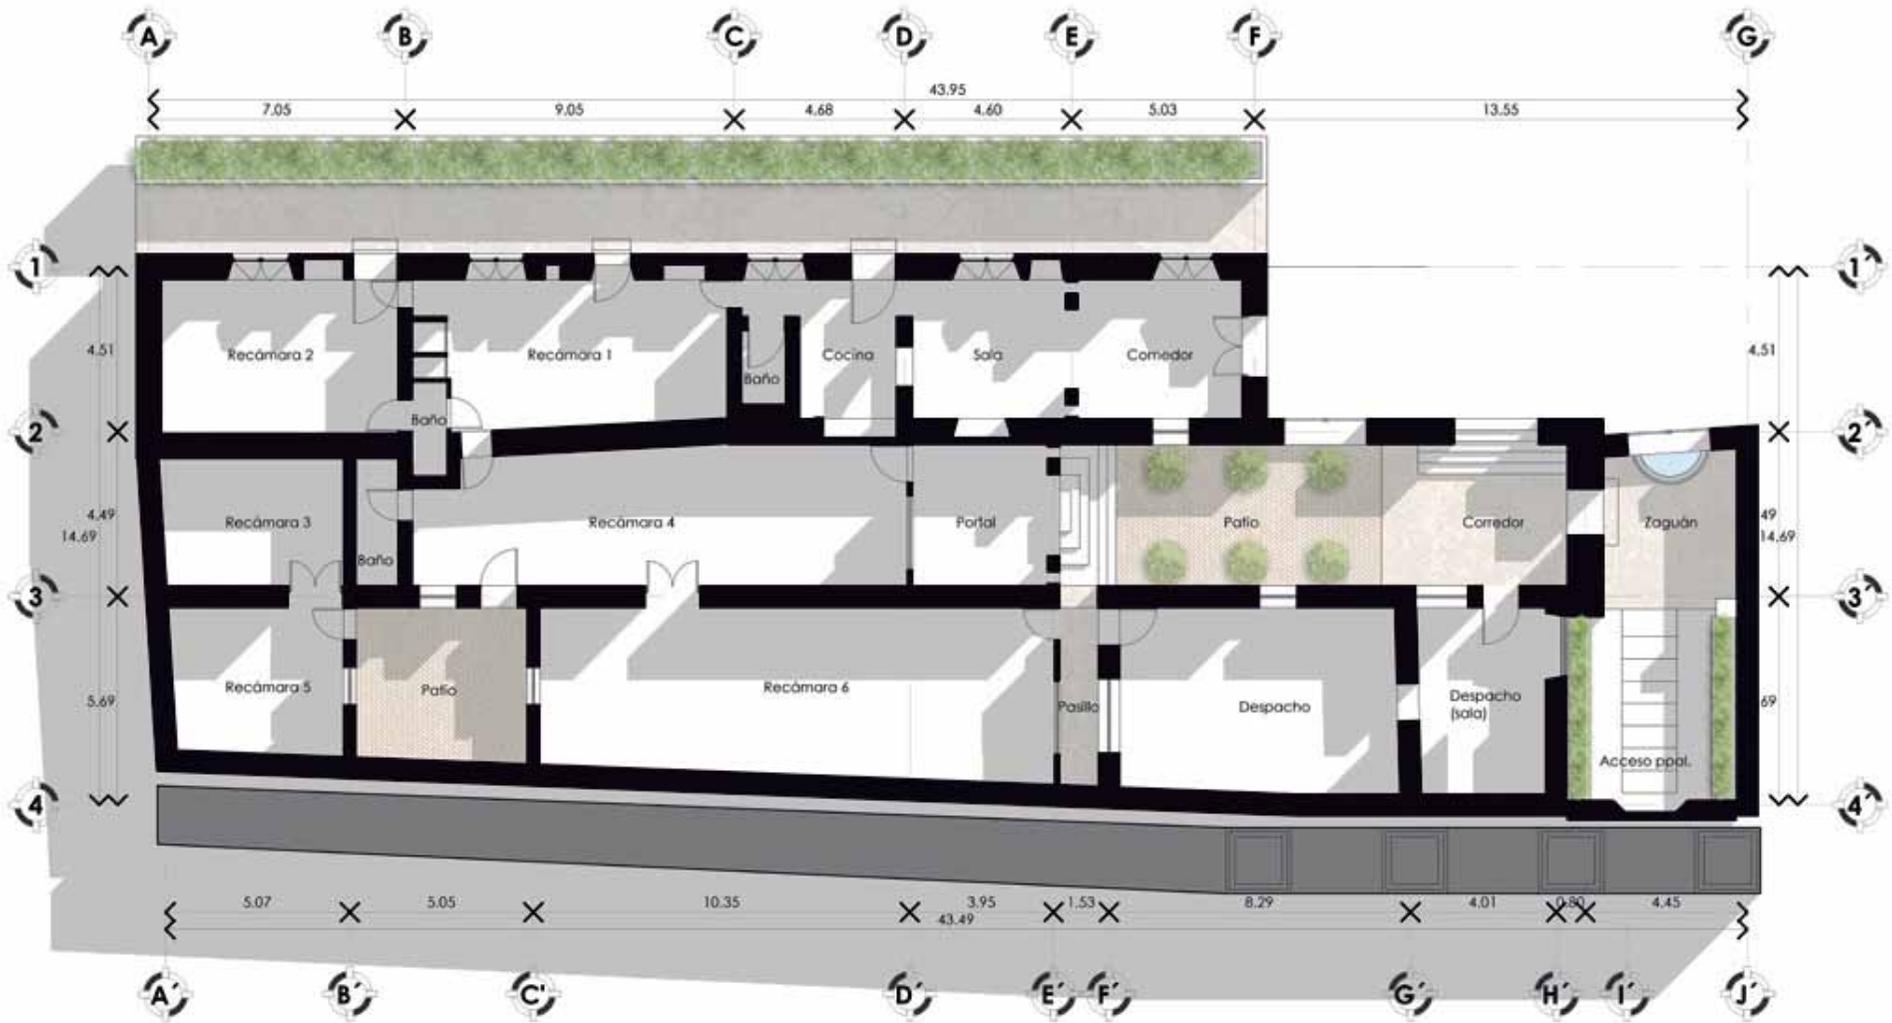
Planta arquitectónica de la Casa. Autoría propia.
